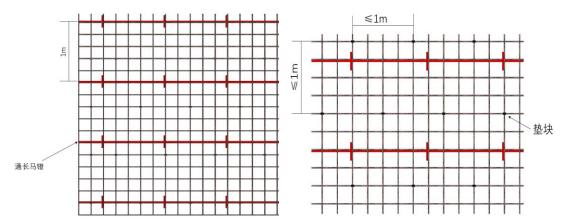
钢筋保护层垫块和马镫布设示意图
